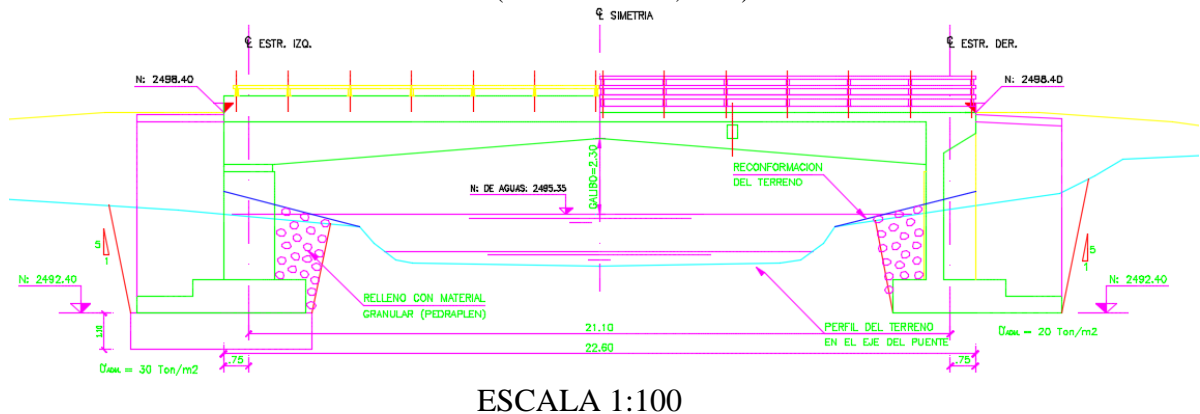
Vista en Elevación. Puente de Hormigón Armado Av. Yaguachi.
